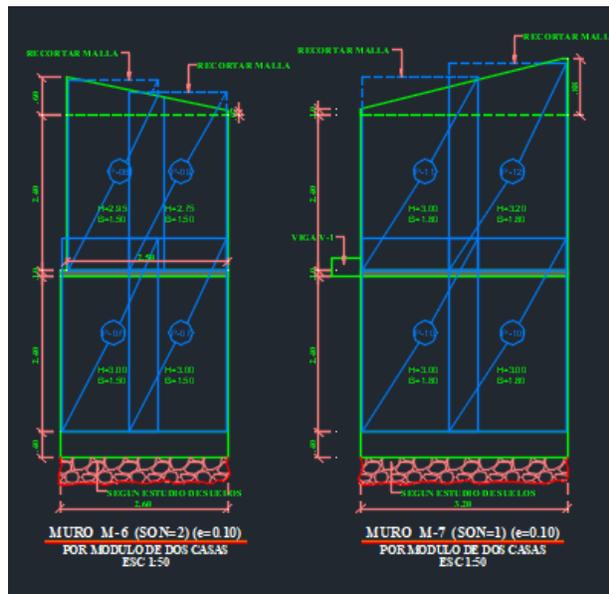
Modulaci3n y Dimensiones Muros M6 y M7 del proyecto Villas del Duruelo.
